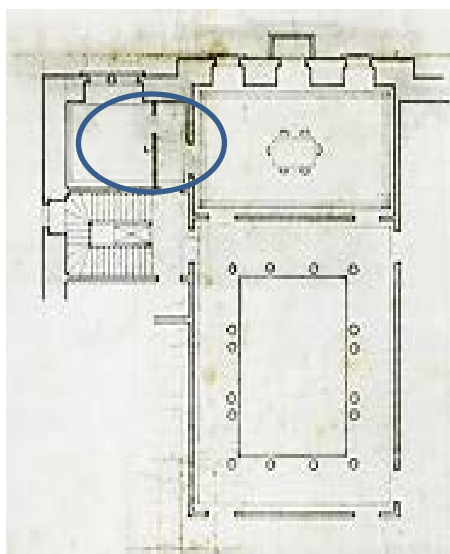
P R C – Planta Piso 0 em 1920.
